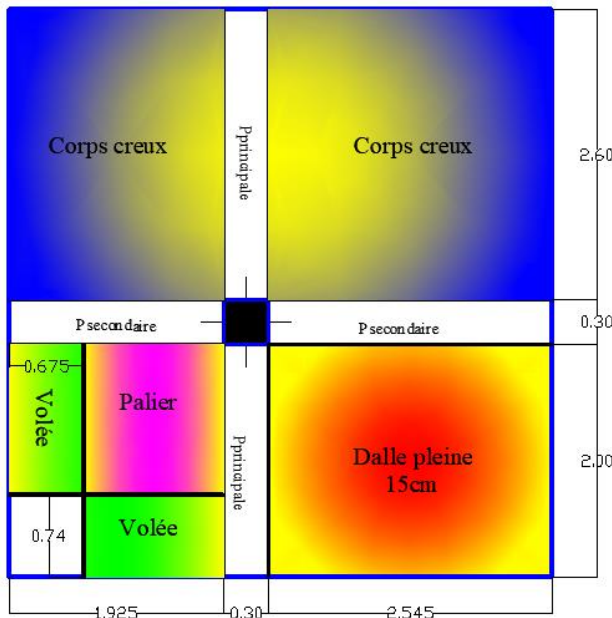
Surface du poteau (P1) du RDC à la terrasse inaccessible
